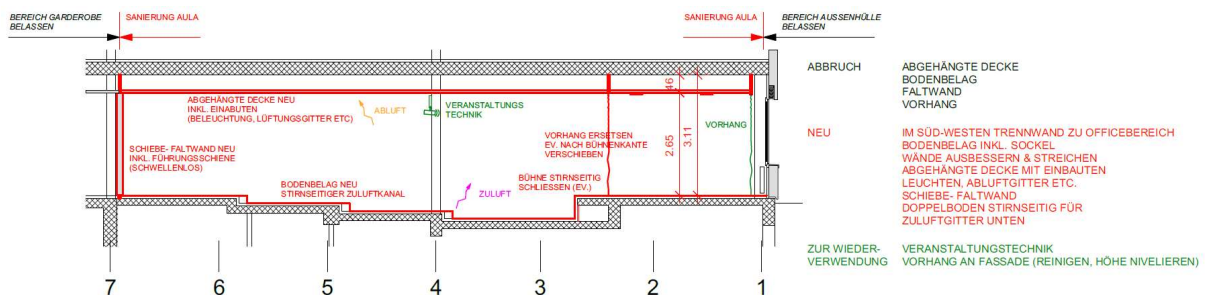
, Planausschnitt: Querschnitt durch Aula; Projekt
